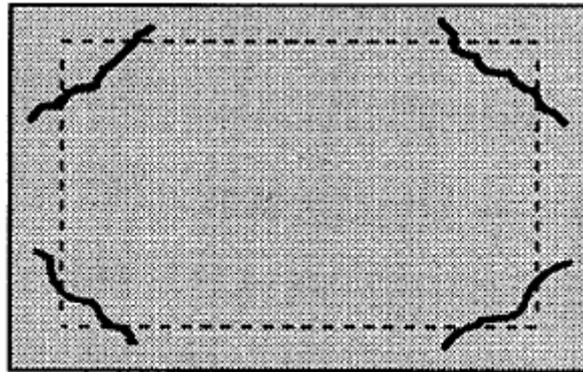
FISURAS DE FLEXIÓN EN VOLADIZO
